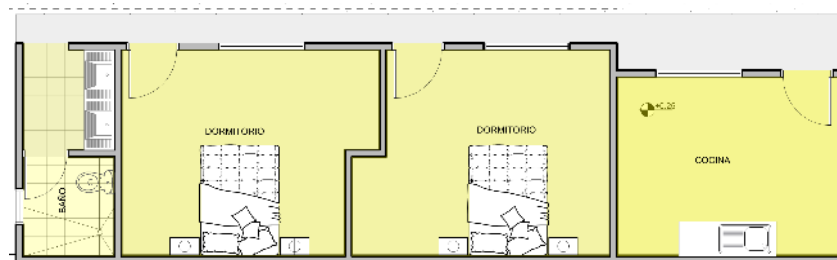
Vivienda "Modalidad mejoramiento" - Planta
